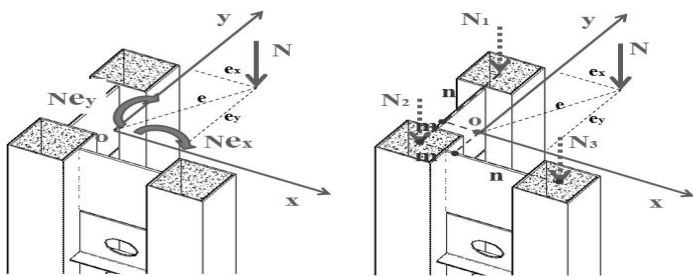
矩形钢管混凝土组合异形柱压弯承载力计算示意图
